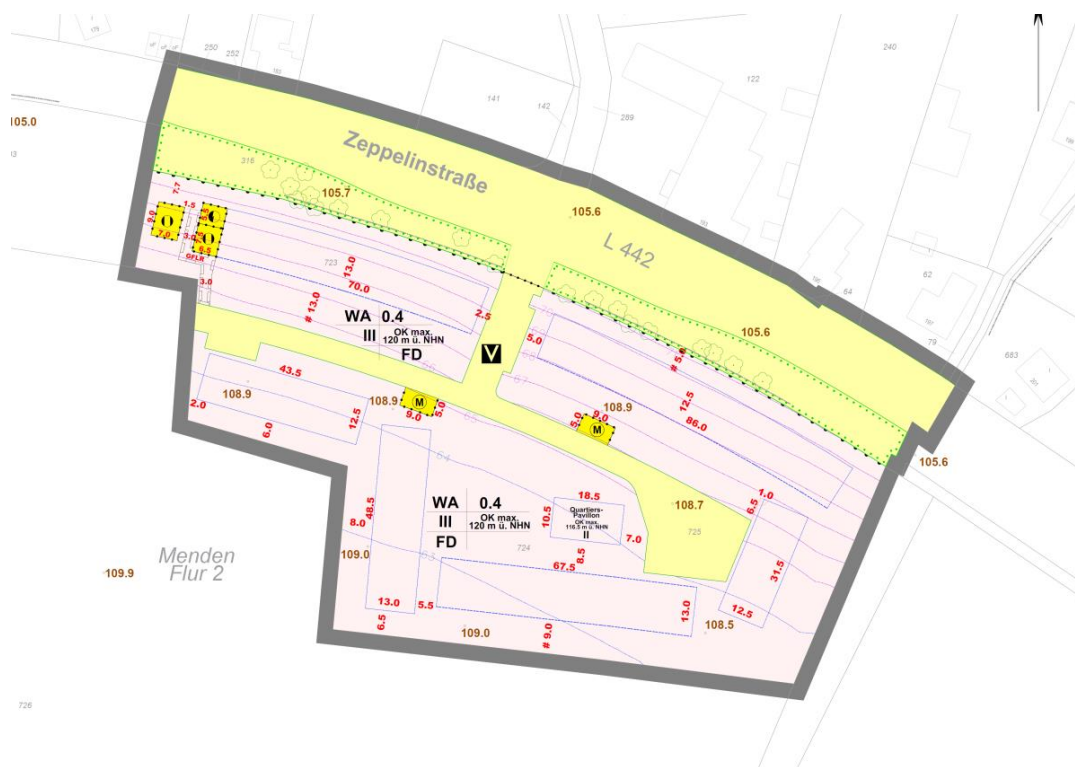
Auszug Entwurf Bebauungsplan „Zeppelinstraße/ ehemalige Stadtgärtnerei – H 21“ der Stadt Mülheim an der Ruhr (Stand 23.10.2024)
